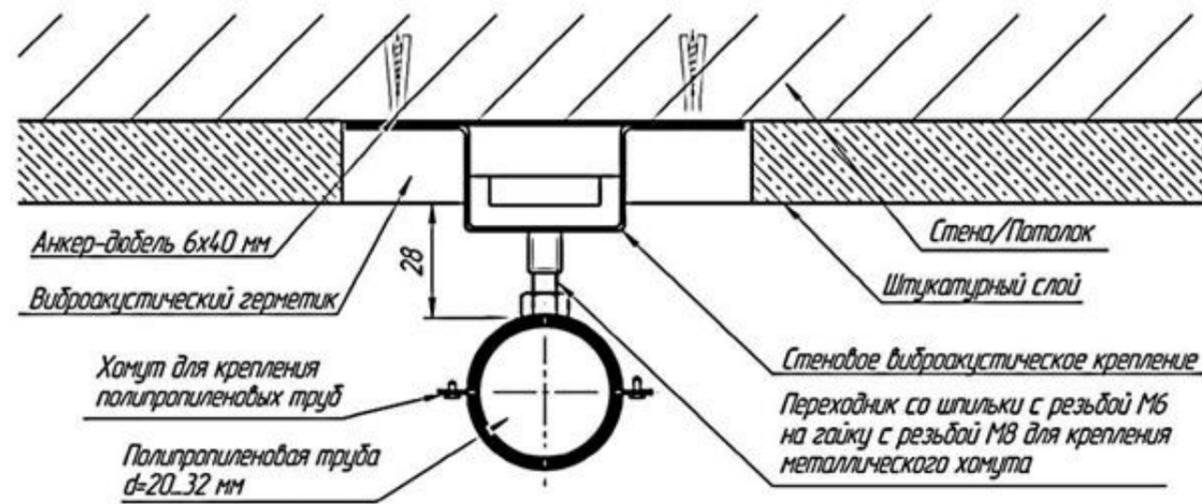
Схемы крепления труб центрального отопления к стенам и перекрытиям с применением современных универсальных стеновых виброакустических креплений
